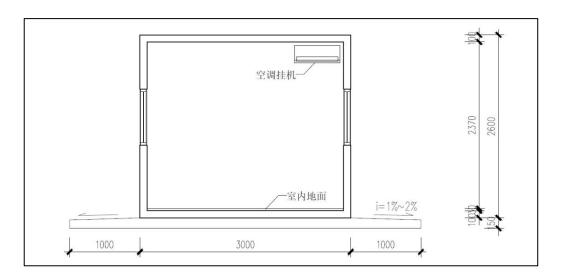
飞行区共享休息区基本单元剖面示意图(单位: mm)
